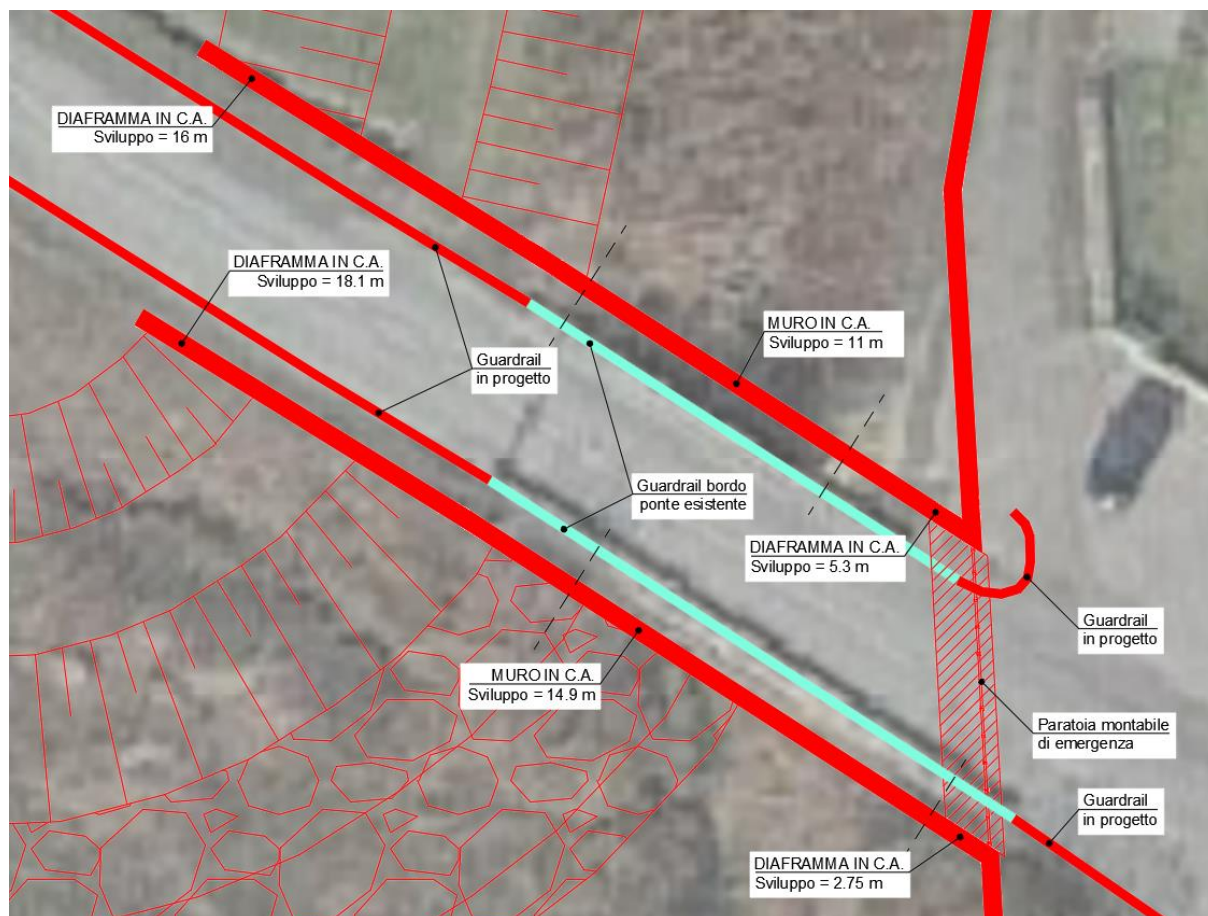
Planimetria di progetto – dettaglio confluenza rio San Pietro nel Bormida
